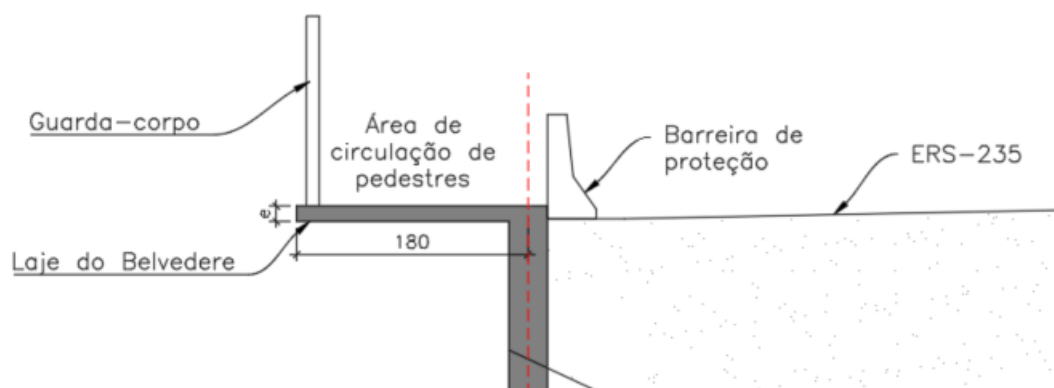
Seção transversal da laje do Belvedere (Fonte: Autora)
